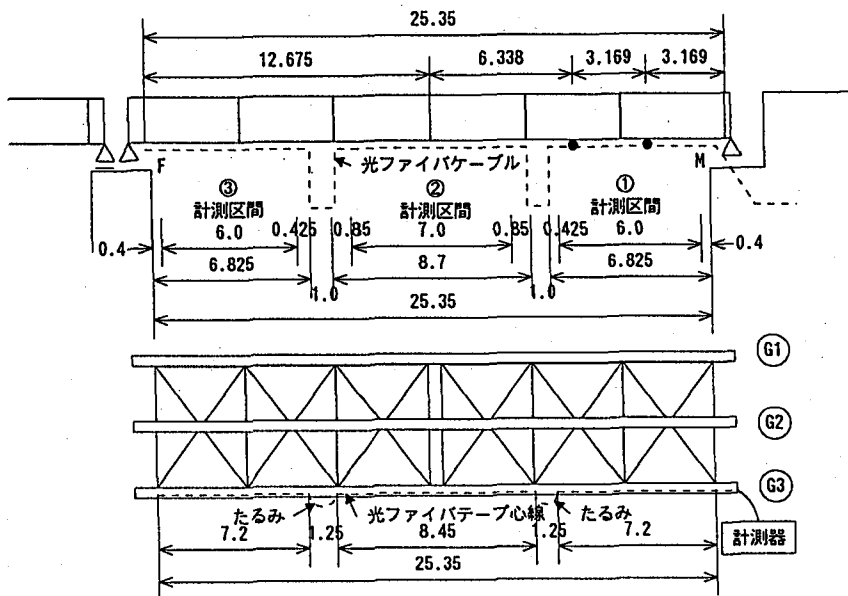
正徳橋の光ファイバ敷設配置図 (単位:m)
